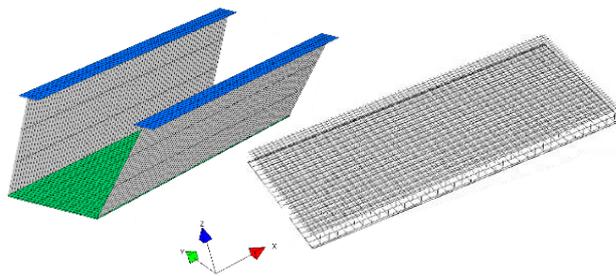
鋼箱桁(左)・鉄筋とリブの配置図
